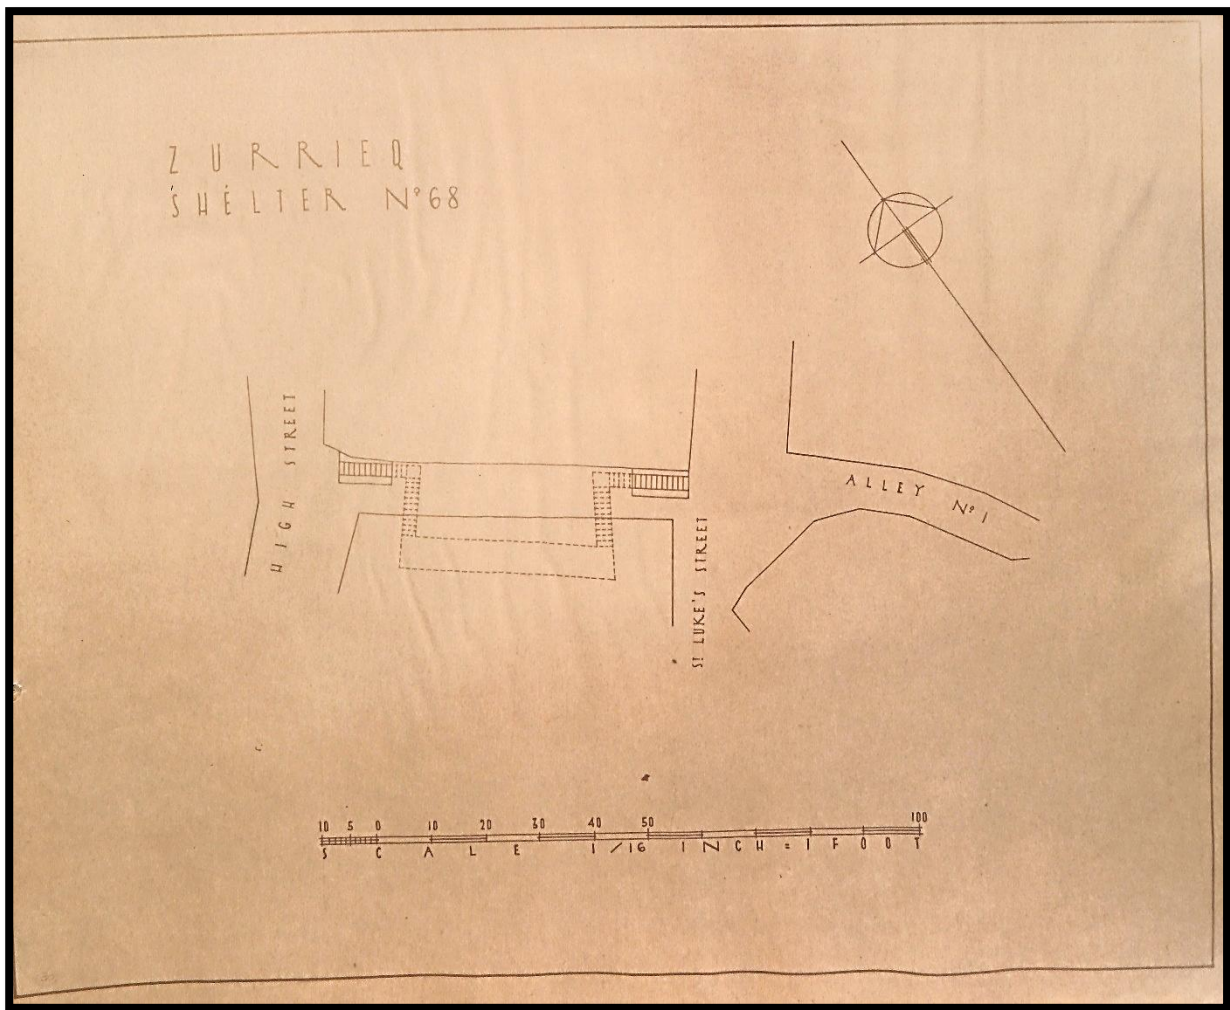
Planta do Abrigo nº68 "High Street – St. Luke's Street* – Alley nº1"
